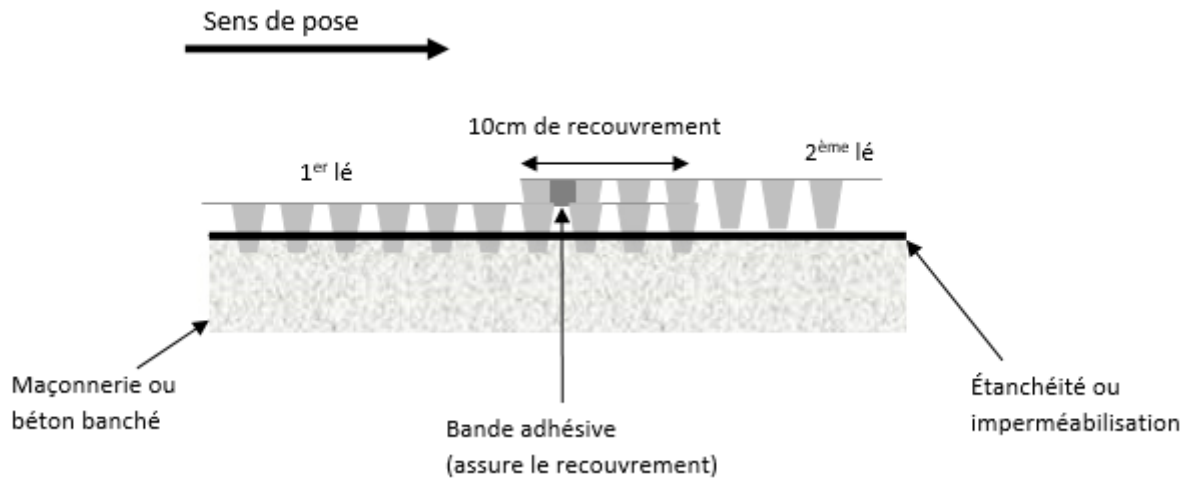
Recouvrement des lés CALINAPPE ST (coupe horizontale)
